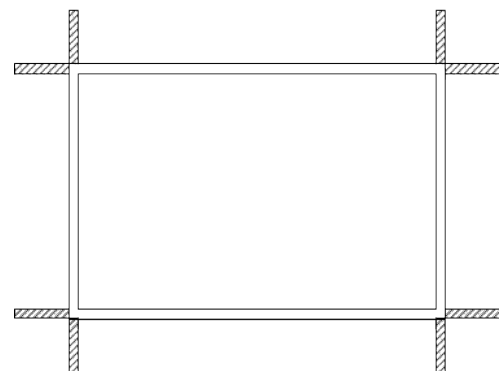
Exemple de plan de masse identifiant les "caissons" formés par les semelles filantes
